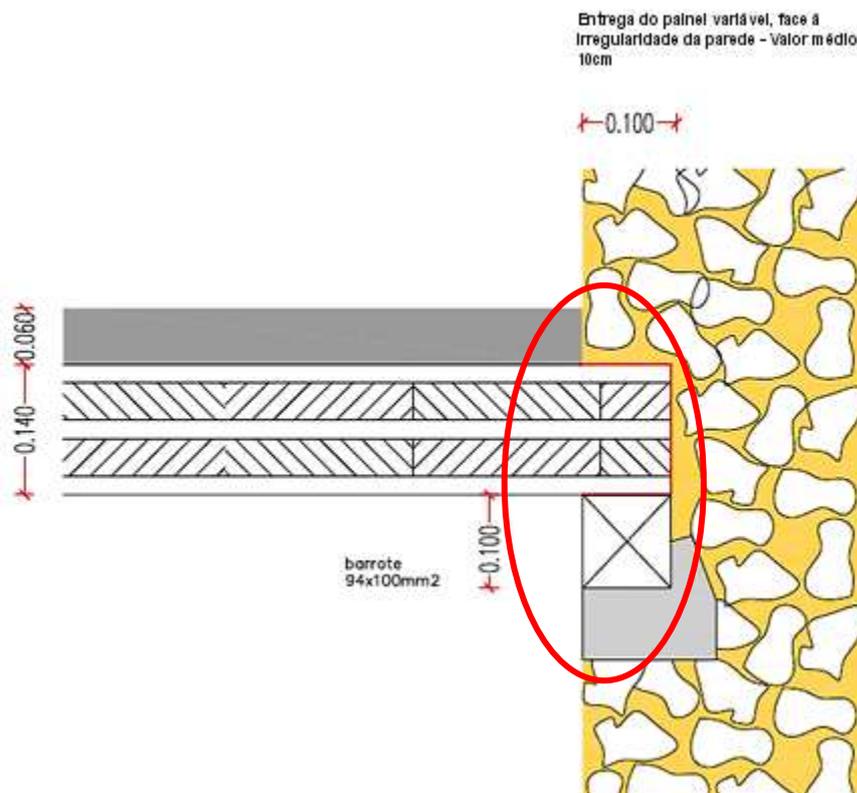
Pormenor construtivo - apoio painel de laje CLT (Cortesia Tisem)
